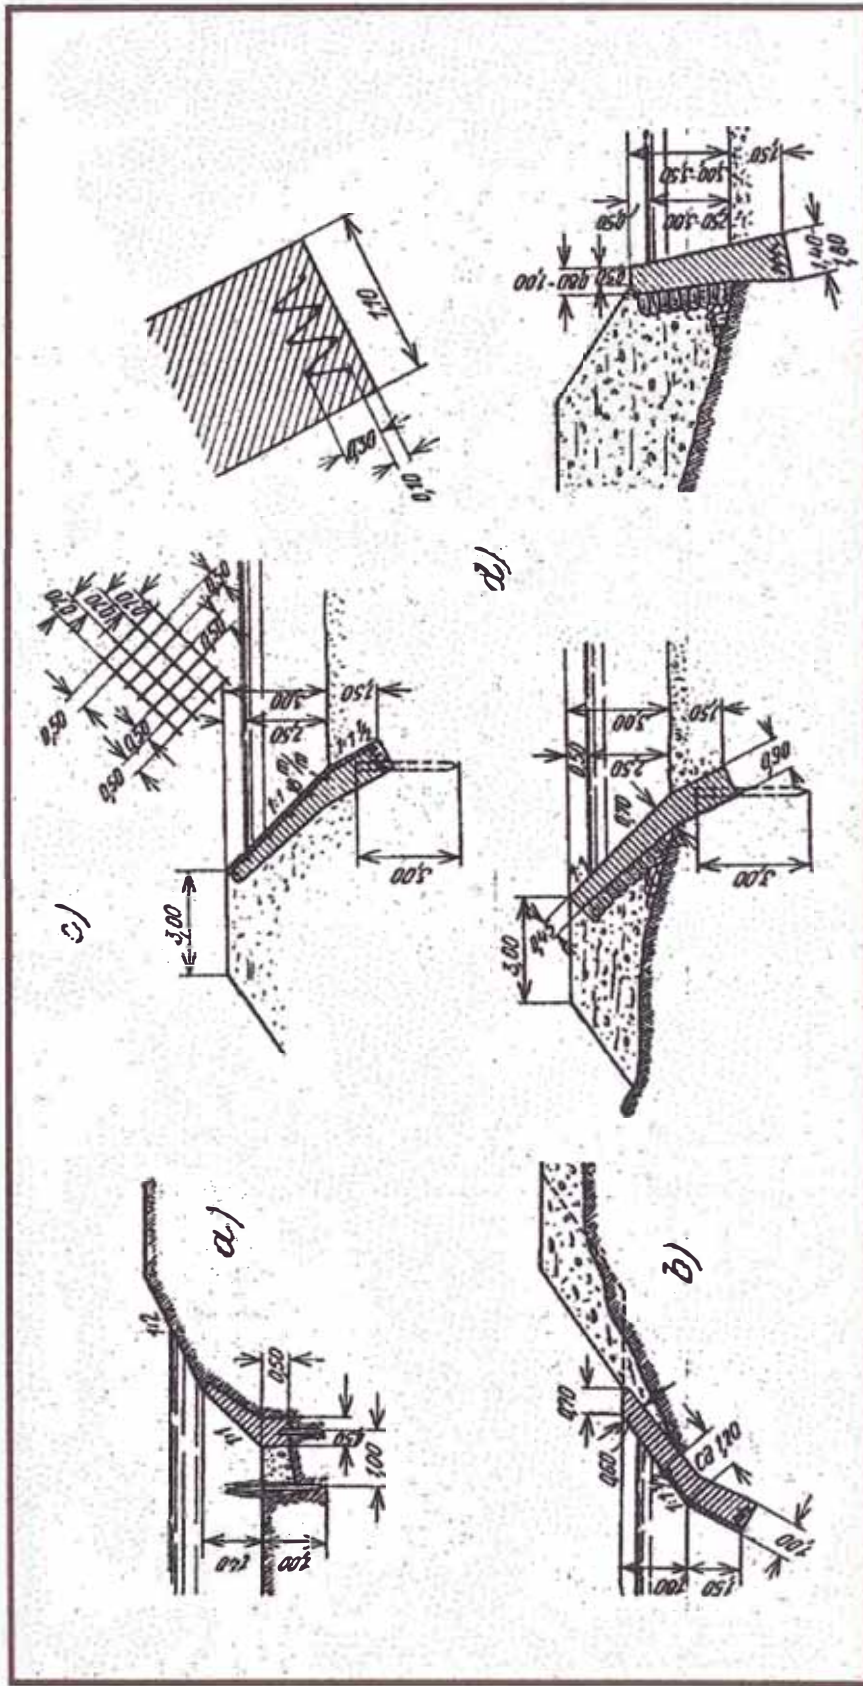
Defensas de Márgenes con Concreto Armado y Concreto Ciclópeo
